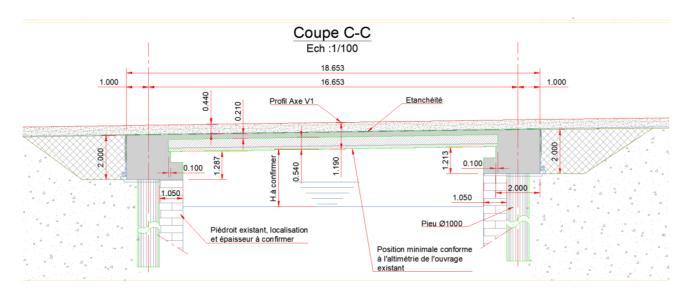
coupe longitudinale fonctionnelle sur ouvrage
